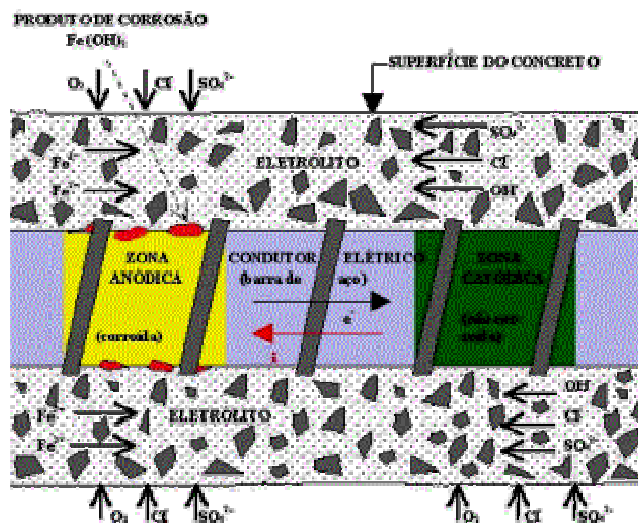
Célula de corrosão em concreto armado - Fonte: Alvim, 2002
